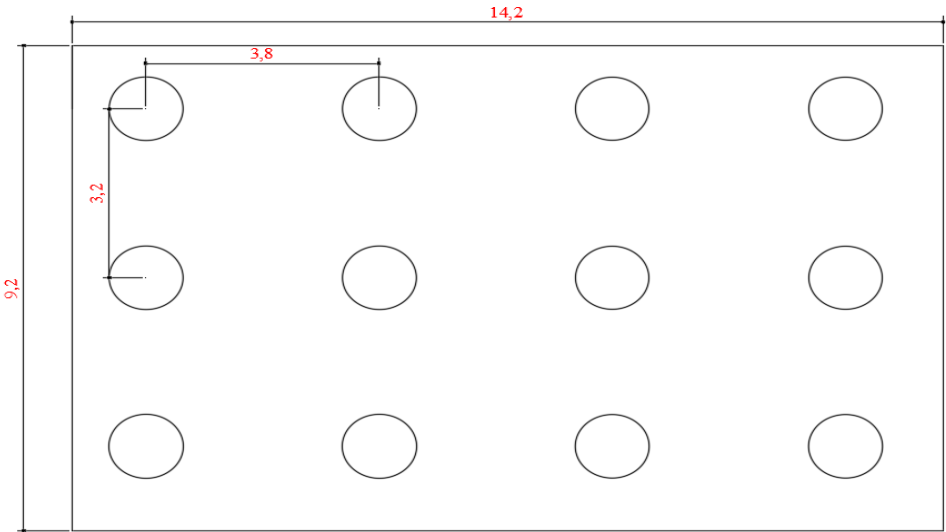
Dispositions des pieux (semelle sous la culée).
